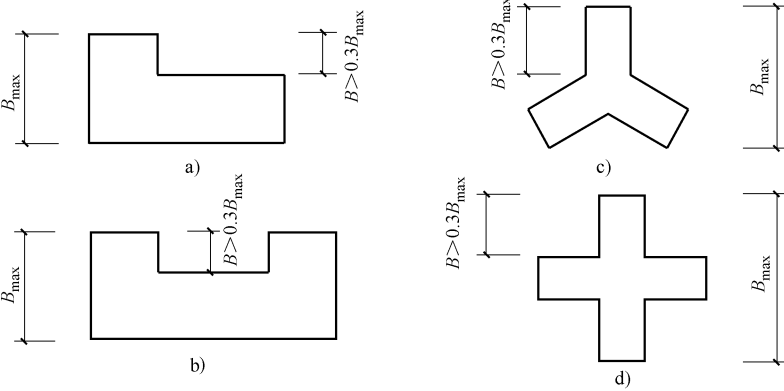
建筑结构平面的凸角或凹角不规则示例
